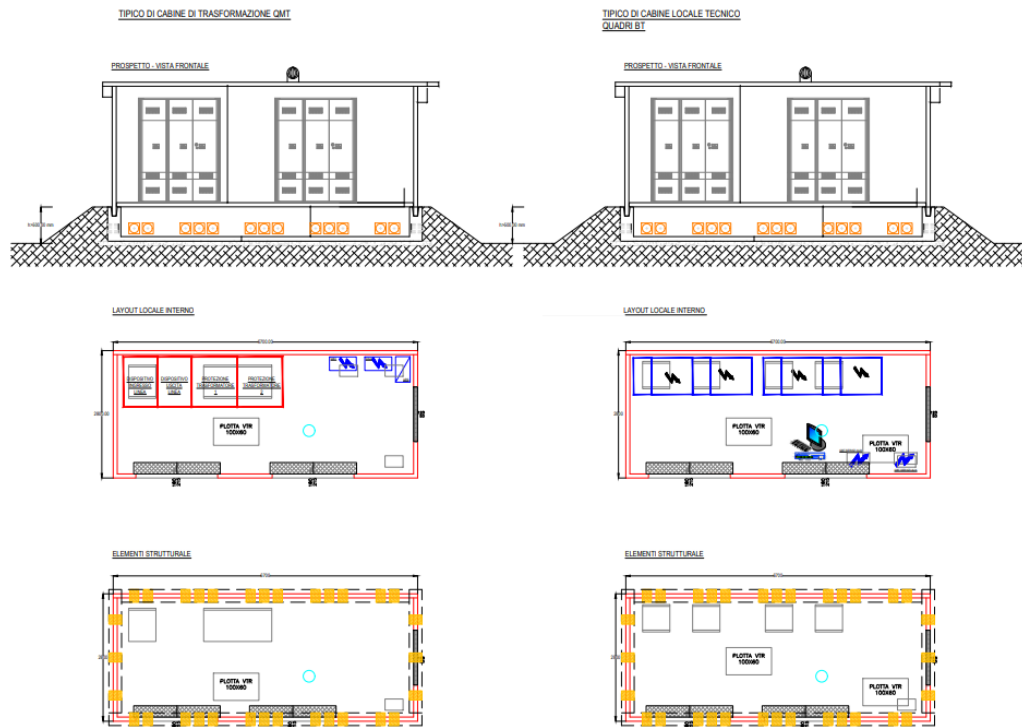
Pianta e prospetto cabine di trasformazione (Power Station)
